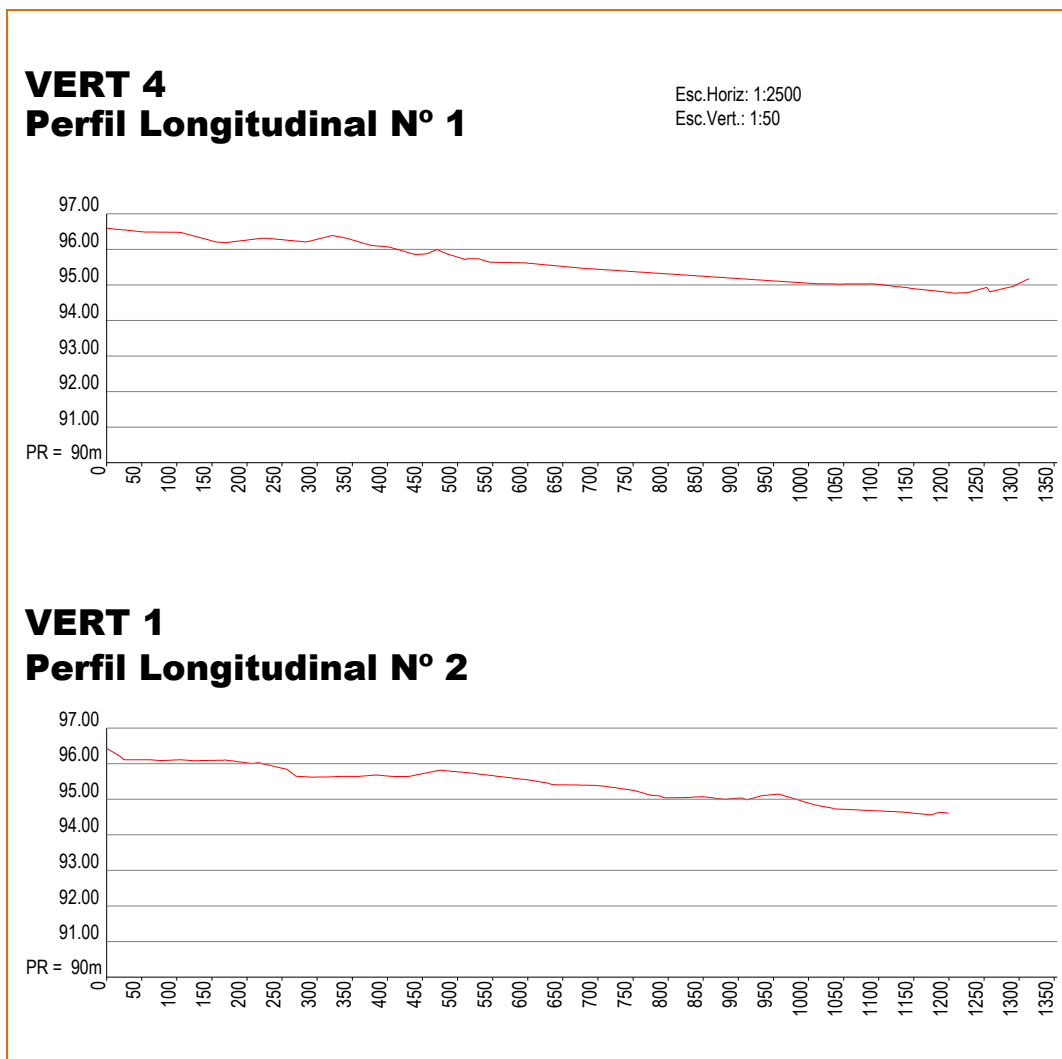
Perfiles longitudinales - VERTEDERO N°4
